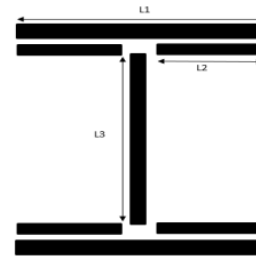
Assemblage soudé poutre- platine.
